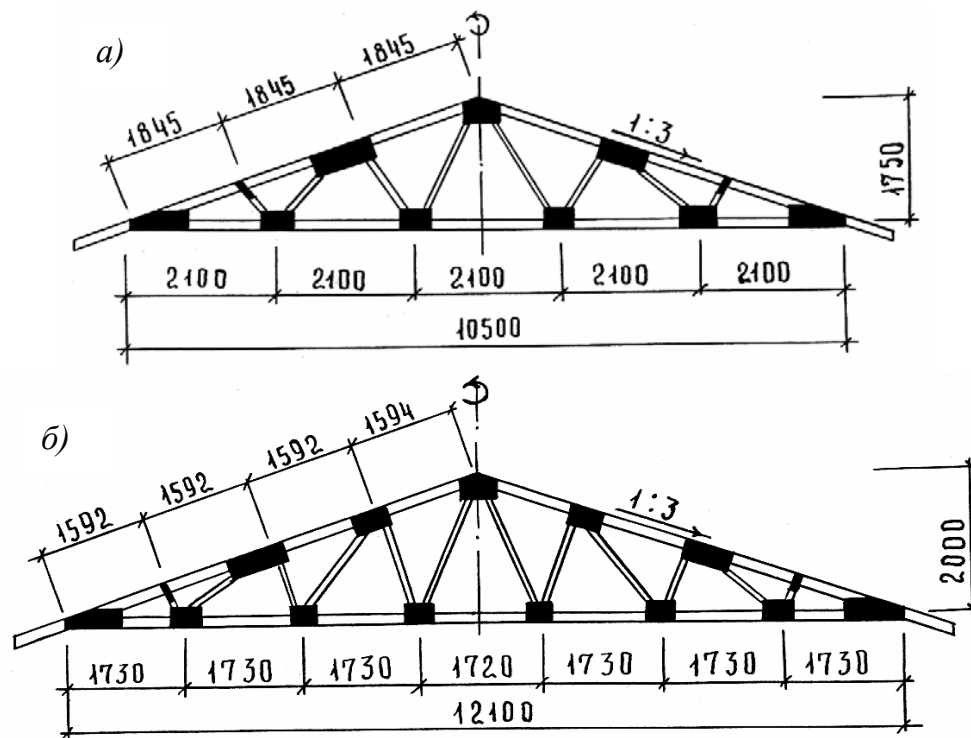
Фермы с узлами на фанерных накладках: а – пролетом 10,5 м; б – пролетом 12,1 м
